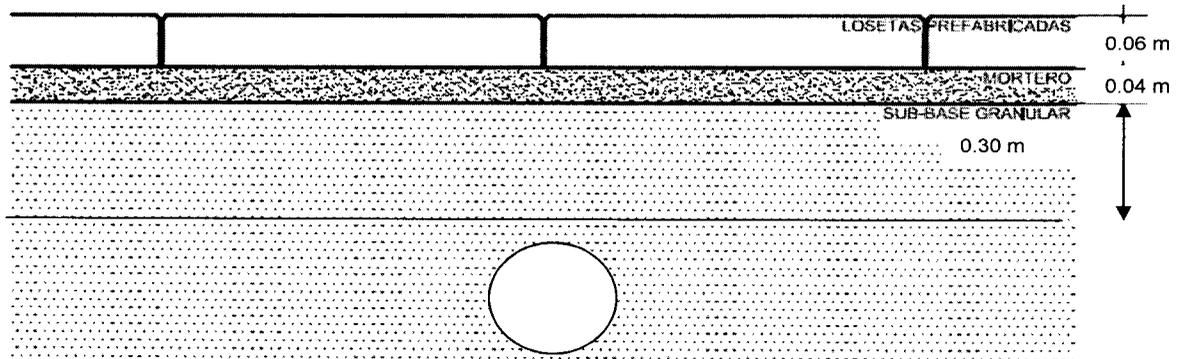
Estructura peatonal con loseta prefabricada apoyada sobre mortero
